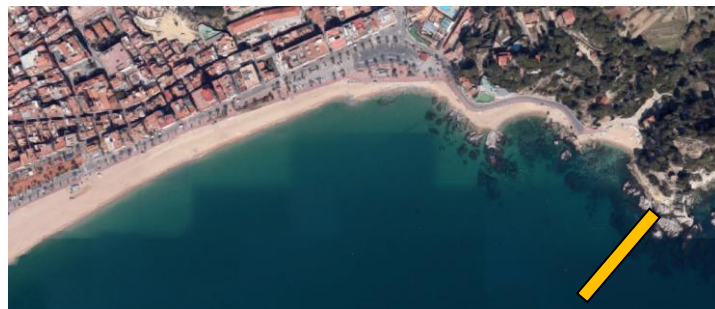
Croquis d'emplaçament de l'espigó a la zona nord (alternativa 3)
